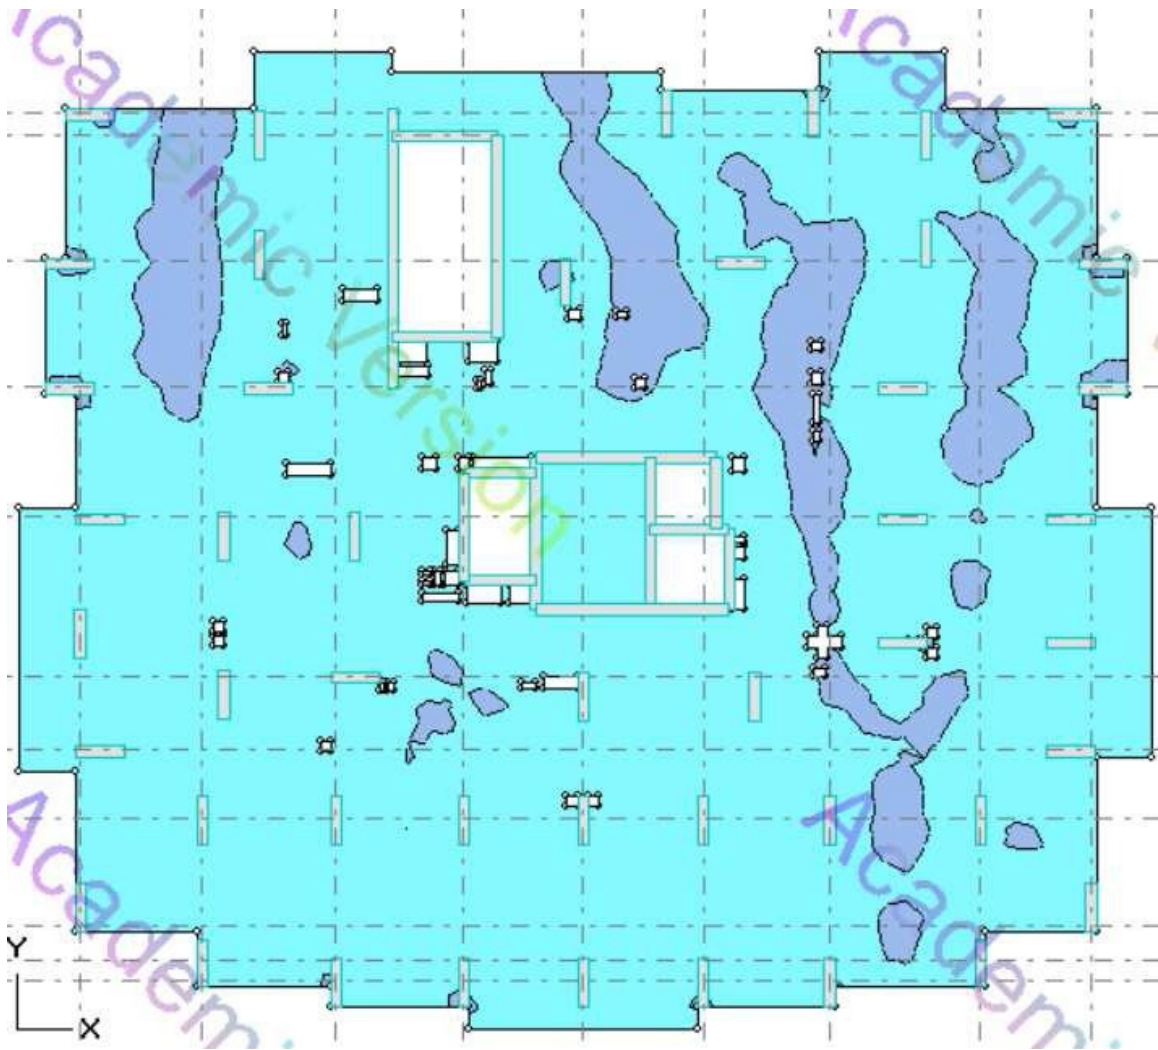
Армування зони нижньої вздовж осі X (A_x).
